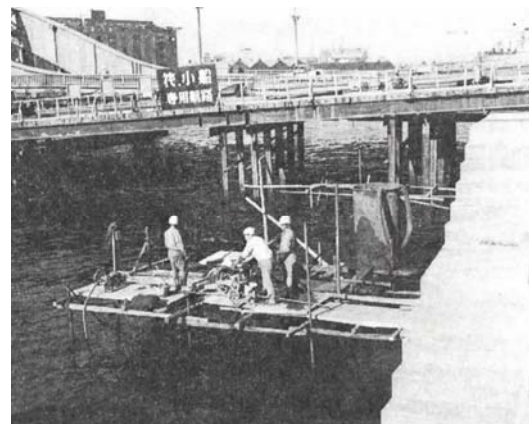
ケーソン間継手部の薬液注入施工状況
